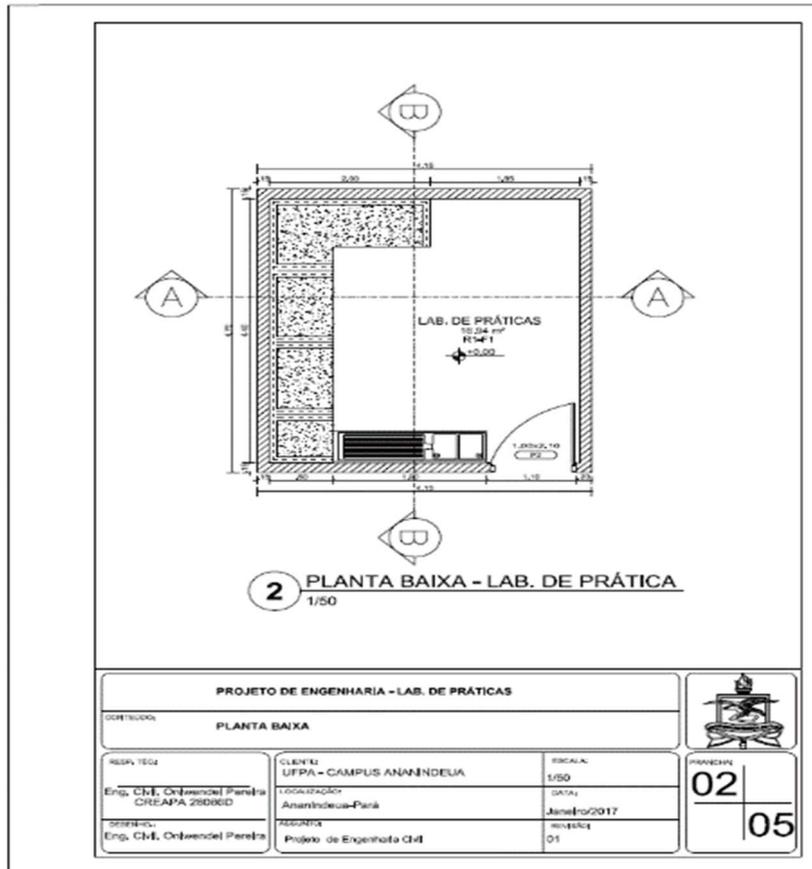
Planta baixa do lab. de práticas tecnológicas, no bloco principal
